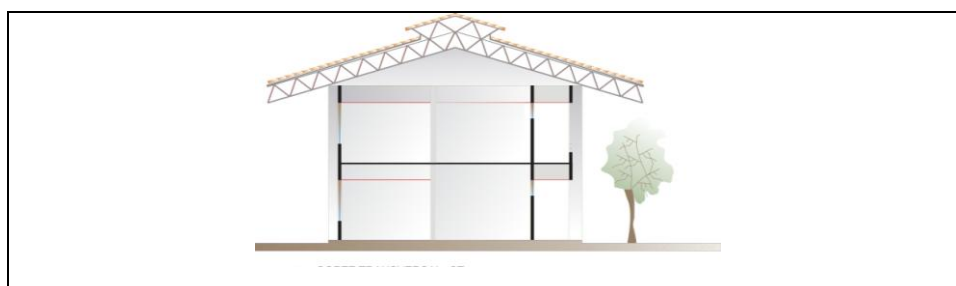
Corte transversal do bloco do Departamento de Transportes
